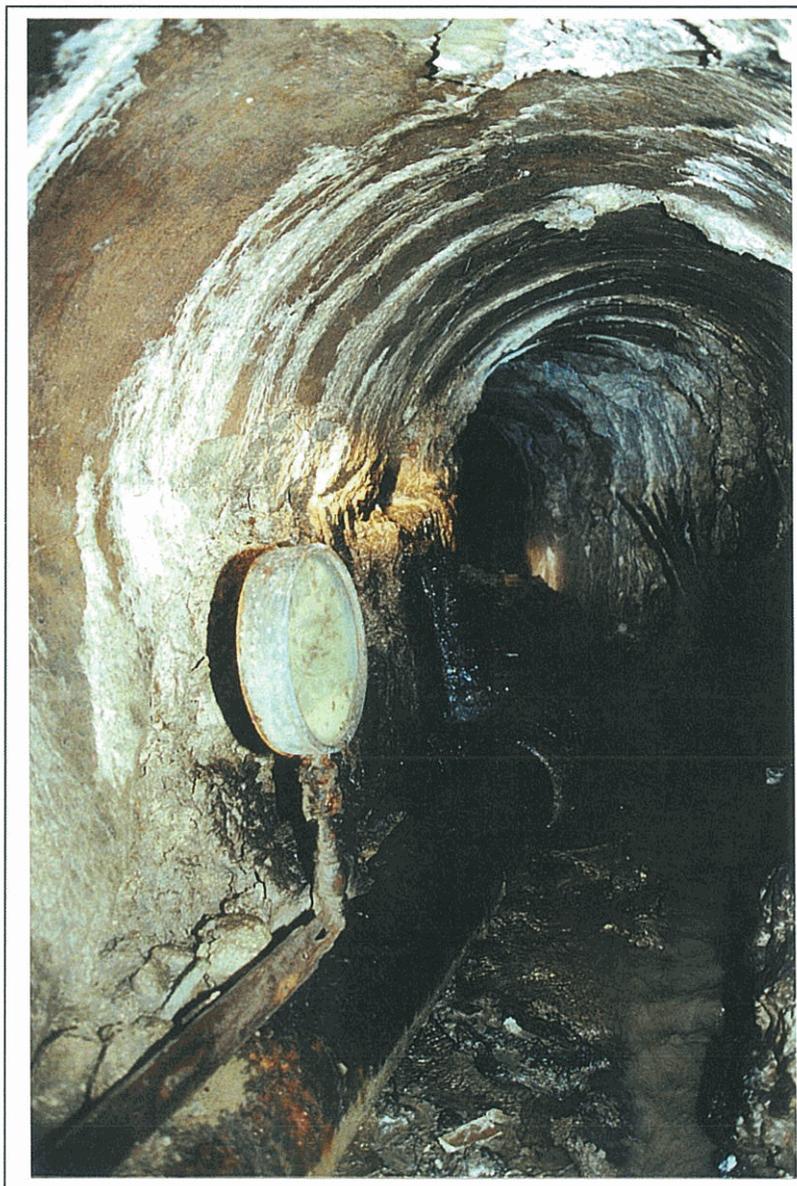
venue d'eau au tympan gauche. Rupture des pieds-droits sous la poussée des terrains.
